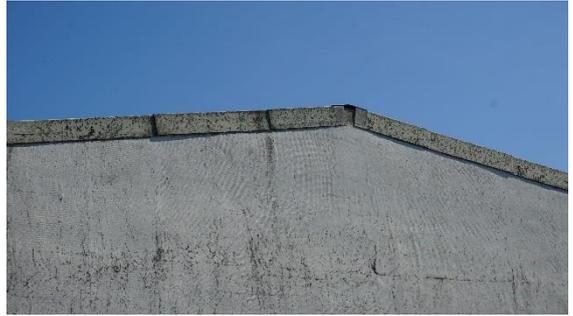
Gebäude 4, Spalt in Dachfirst
